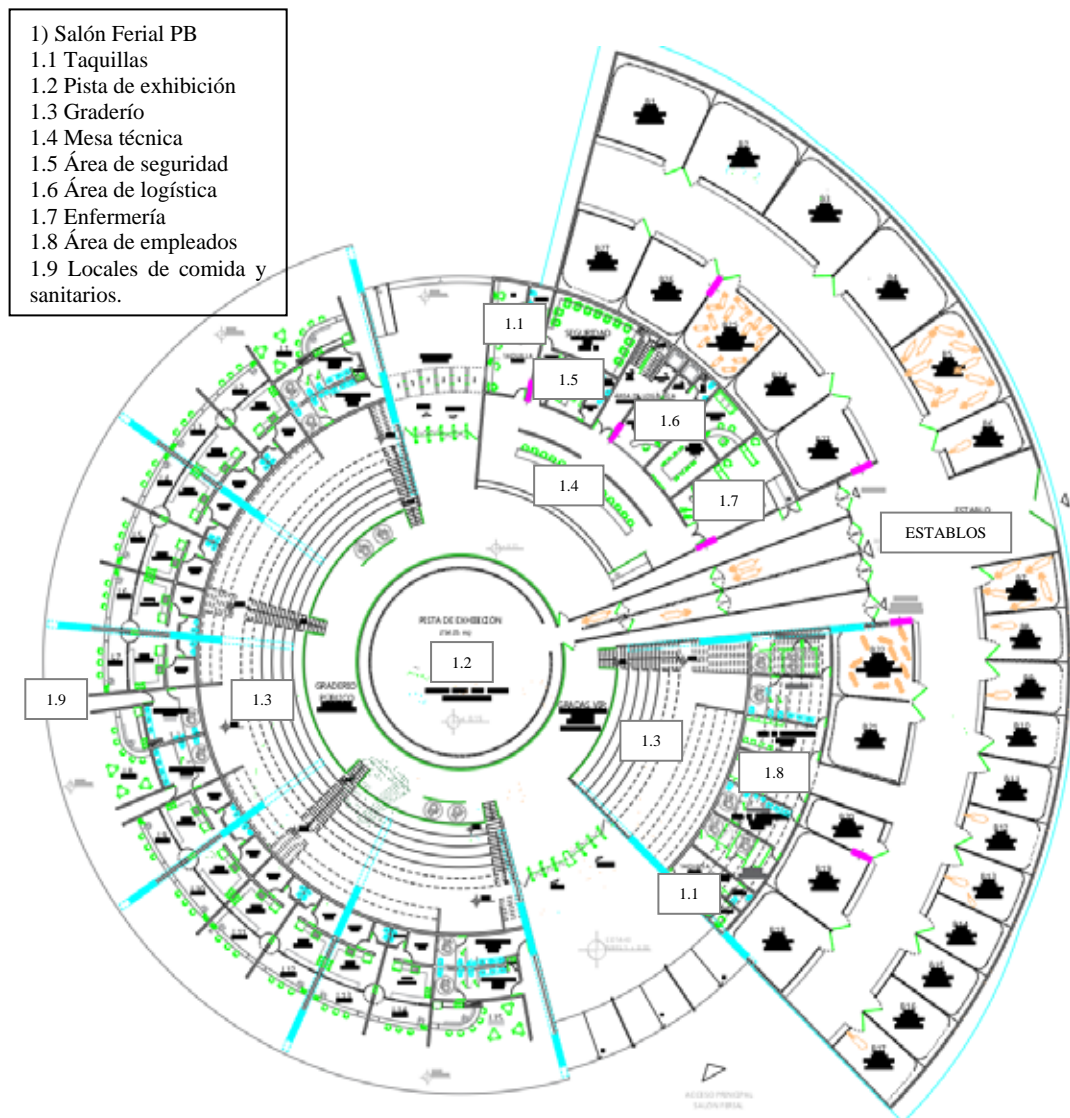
Planta baja salón ferial y establos. La Autora (2020)
